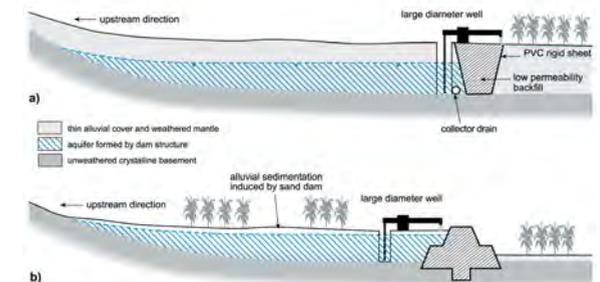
Profil typique d'un barrage souterrain (Source : GWMATE)
